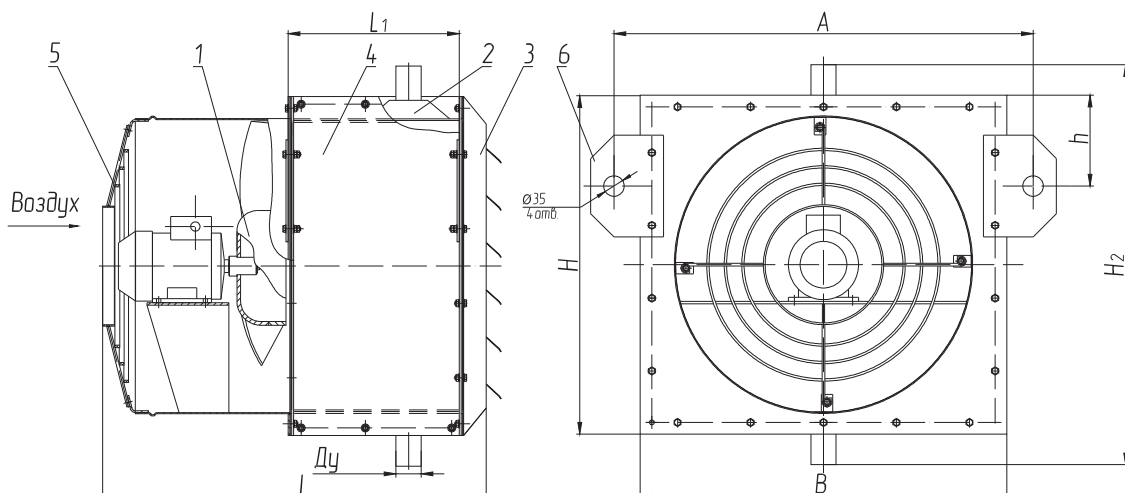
Габаритные, установочные и присоединительные размеры агрегатов АО-ПВО
